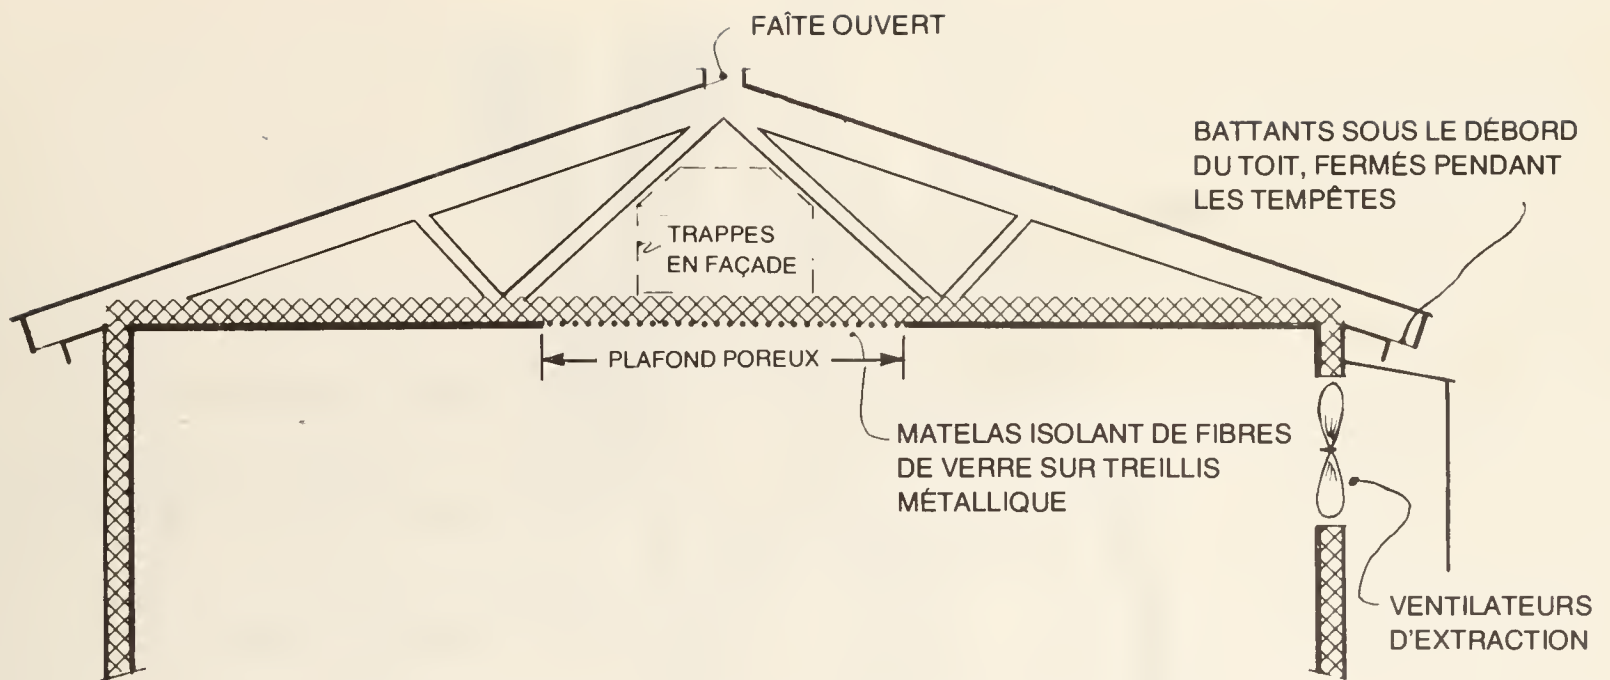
Coupe transversale d'une étable ventilée par un plafond poreux.
